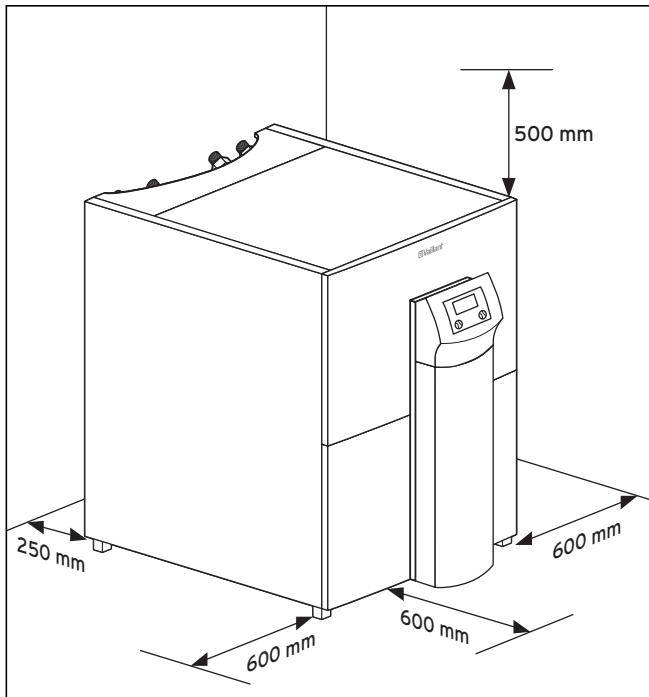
Mindestabstände zur Aufstellung der Wärmepumpe
